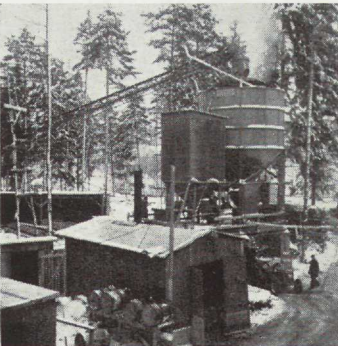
Betongstation med elevator, grusjickor och betongblandare på mark.
